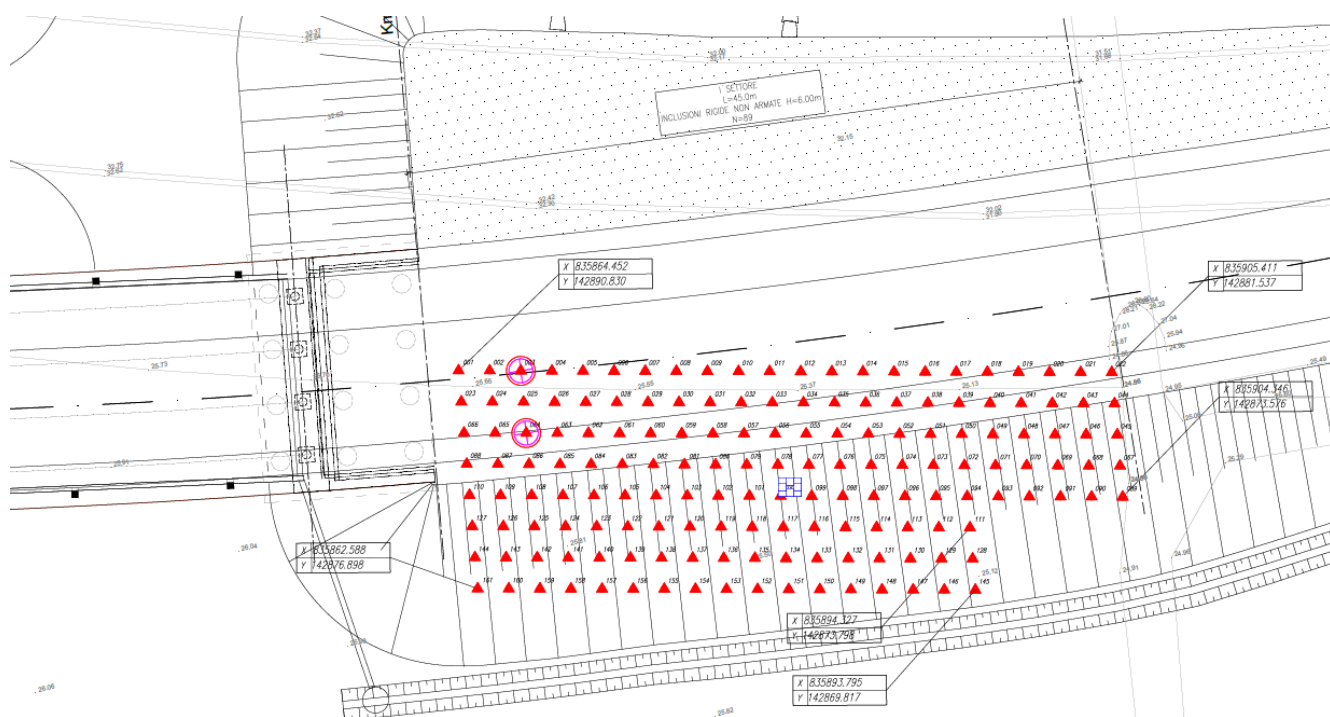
Rilevato di approccio spalla B – Planimetria di progetto delle inclusioni rigide
